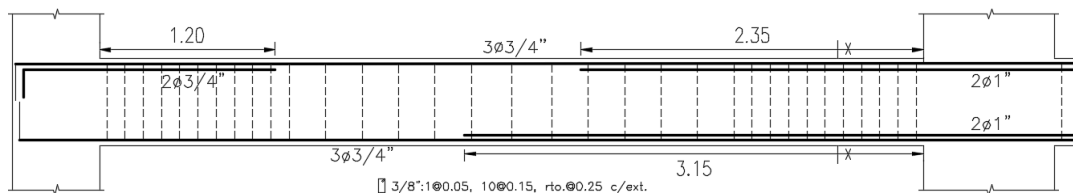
Elevación del primer tramo de la viga VT-02.
